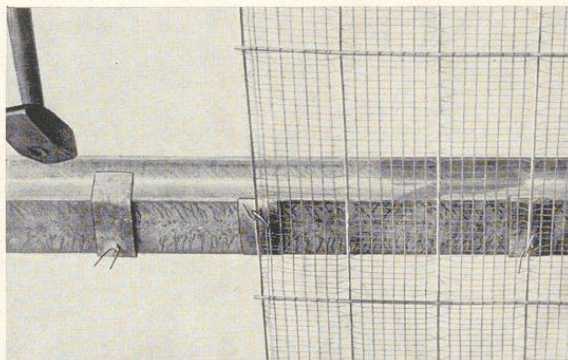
Befestigen der Baustahlmatten an eisernen Trägern mit verzinkten Laschen
